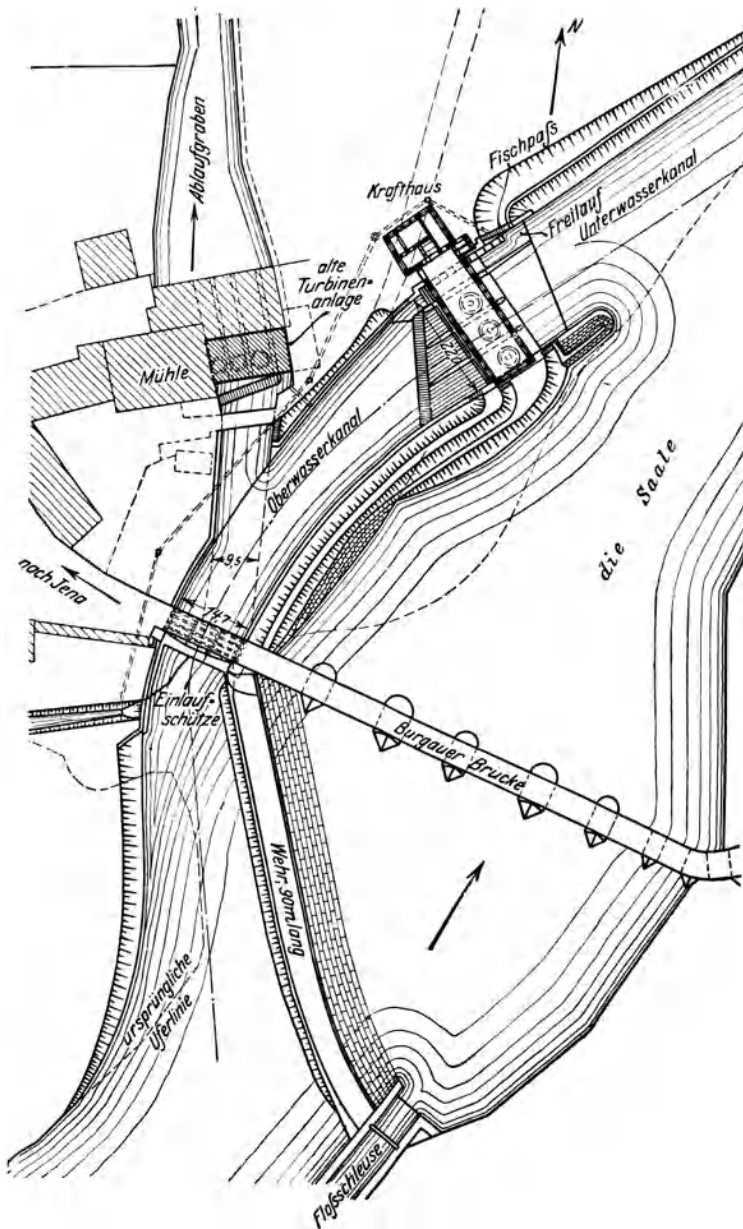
Lageplan der Niedergefälle-Wasserkraftanlage bei Burgau a. S.
